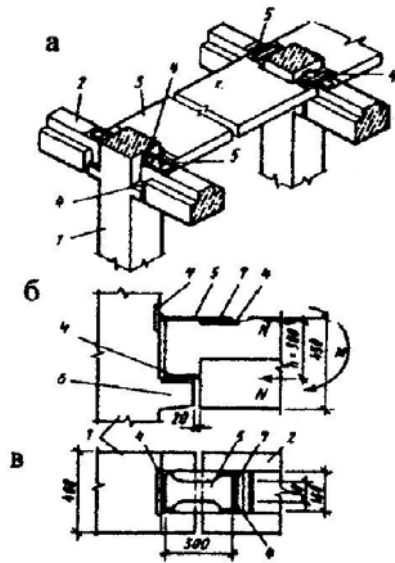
Вузол сполучення ригеля з колоною і багатопустотними плитами перекриттів:
